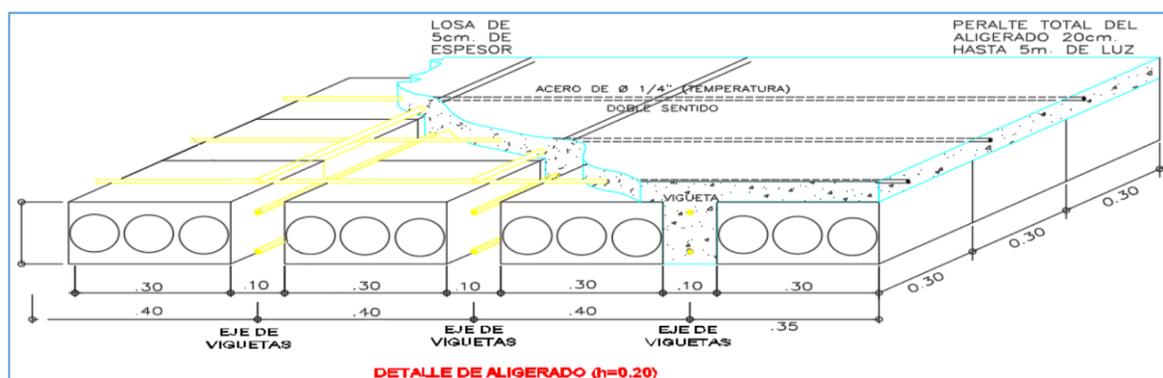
Detalle típico en 3D de la losa aligerada con los bloques de concreto ligero
